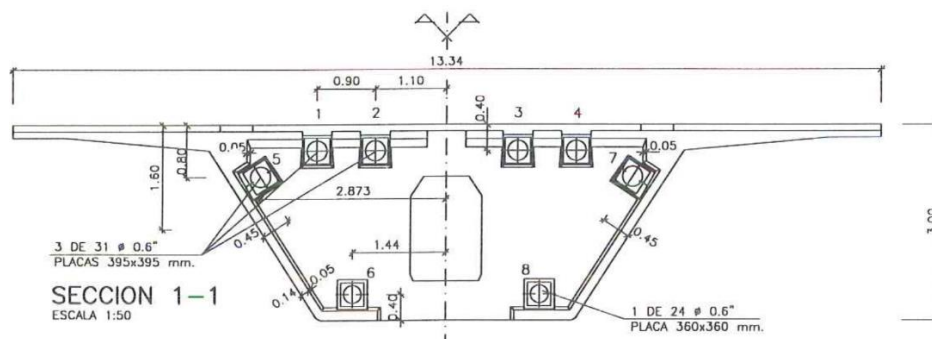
Sección tipo de anclajes en mamparo de pilas. (Fuente: [2]).
